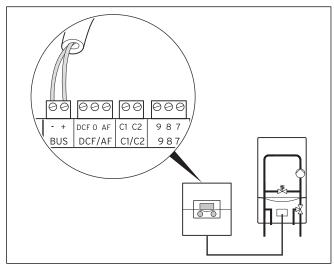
Collegamento dell'apparecchio di riscaldamento
